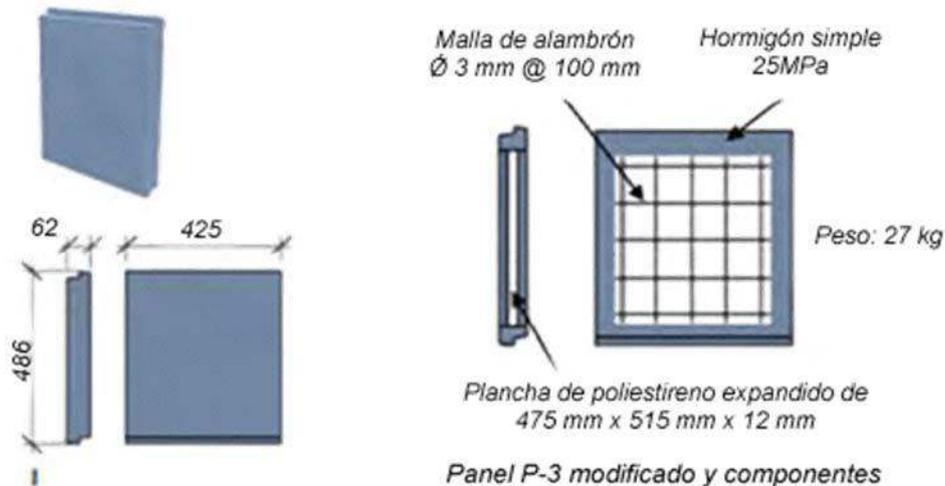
Ejemplo de panel aligerado de 425 mm denominado P-3.
